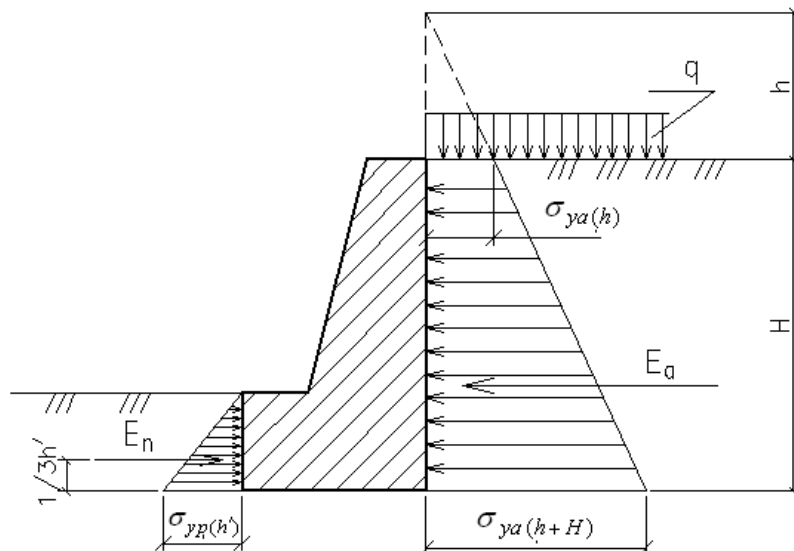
Расчетная схема подпорной стены с пригрузом
